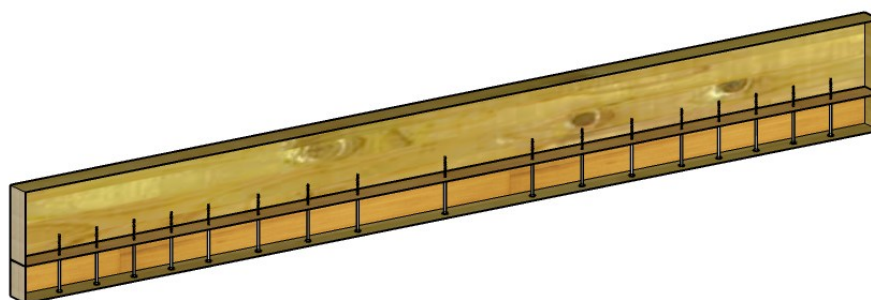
Renfort bois en face inférieure assemblé par vis à 90°
